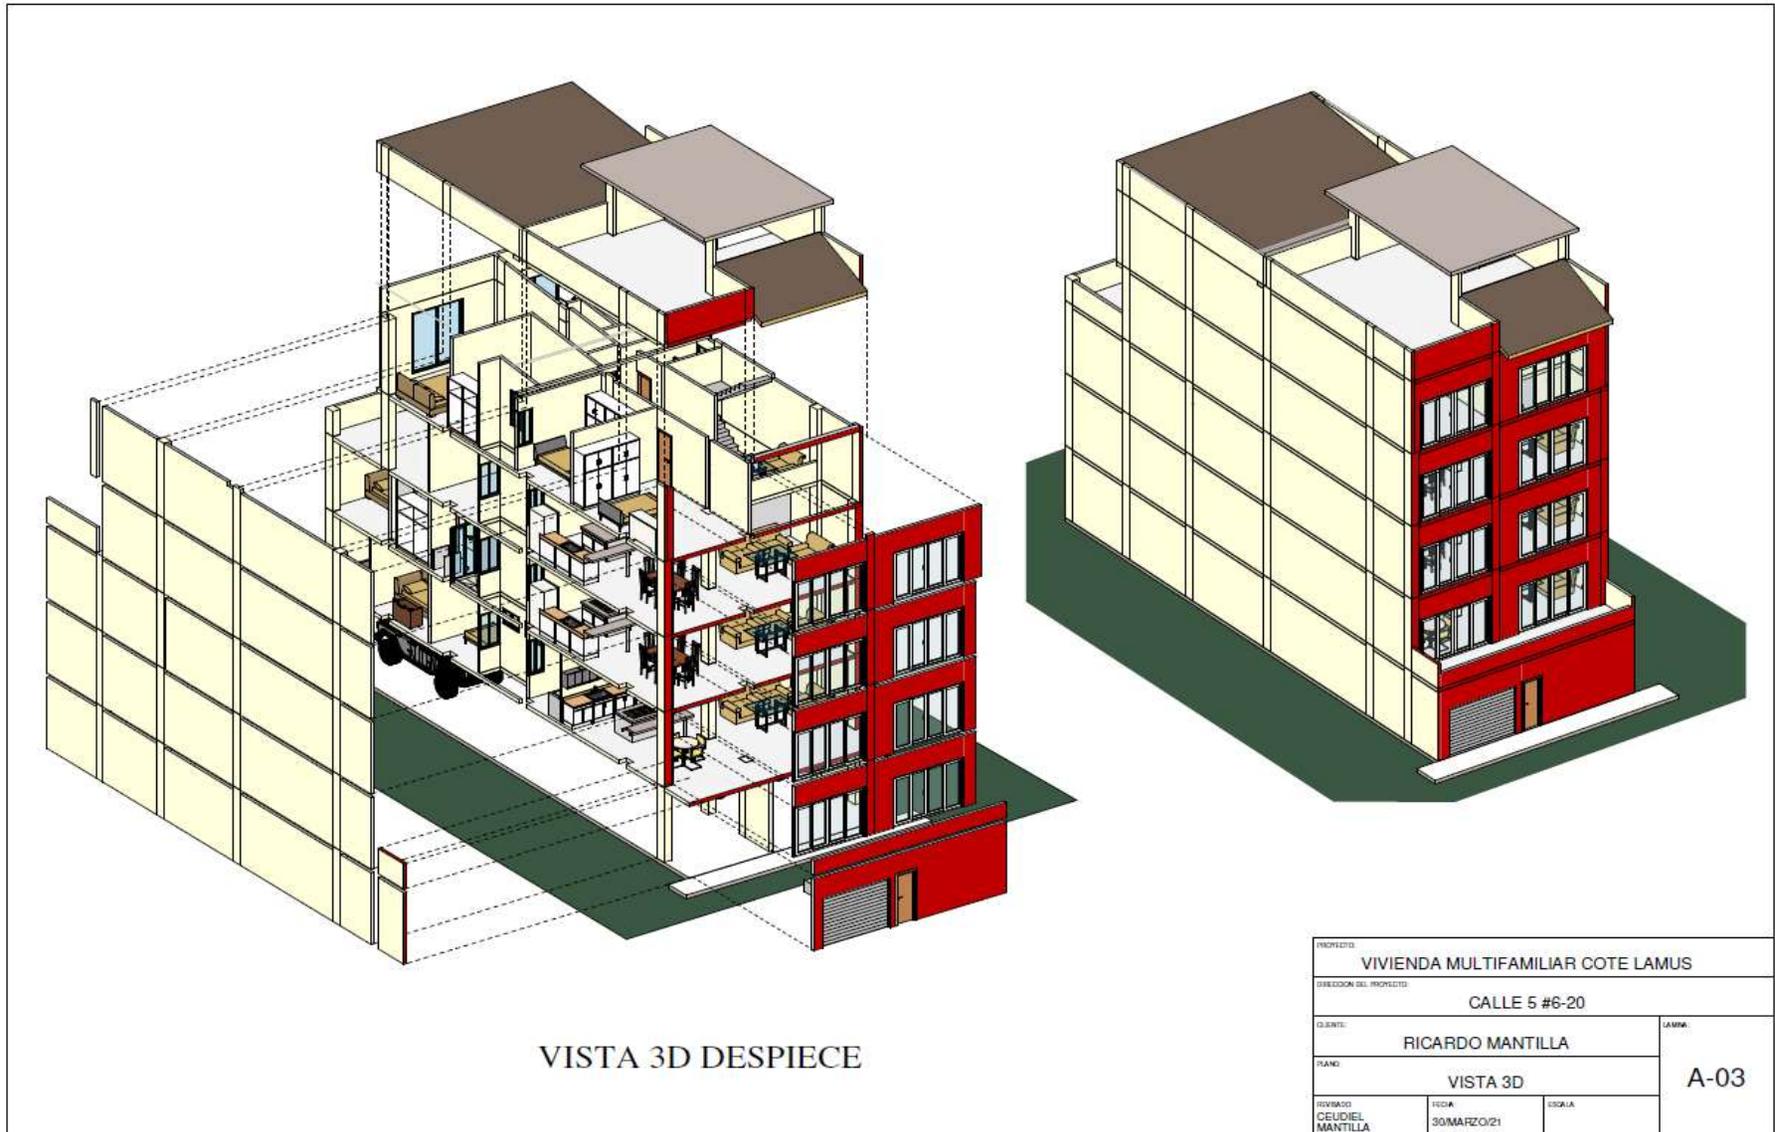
Despiece arquitectónico. Diseño: Revit 2021
